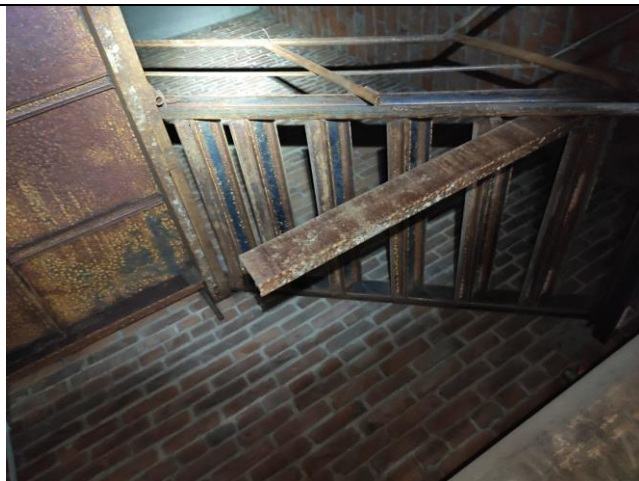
Коррозия металлических элементов лестниц и площадок в осях Г-Д/24-26.
